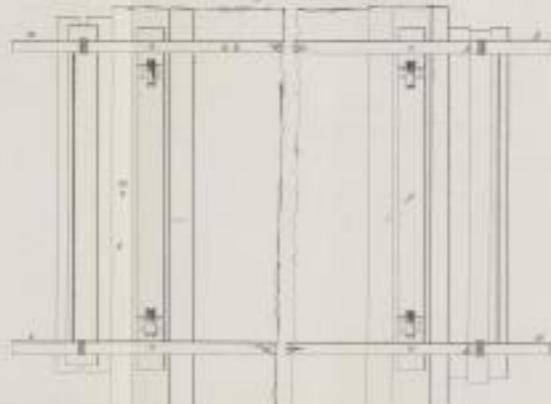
Grundriss einer abnehmbaren Brücke
